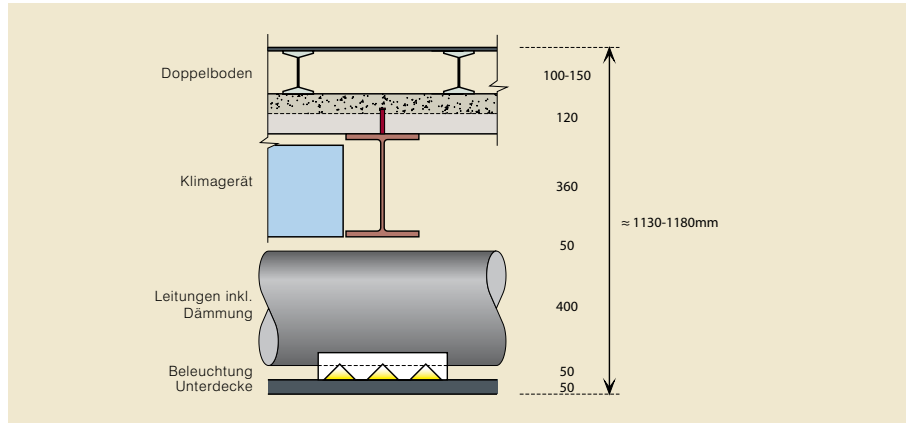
Deckepaket inklusive Installation und abgehängter Decke
